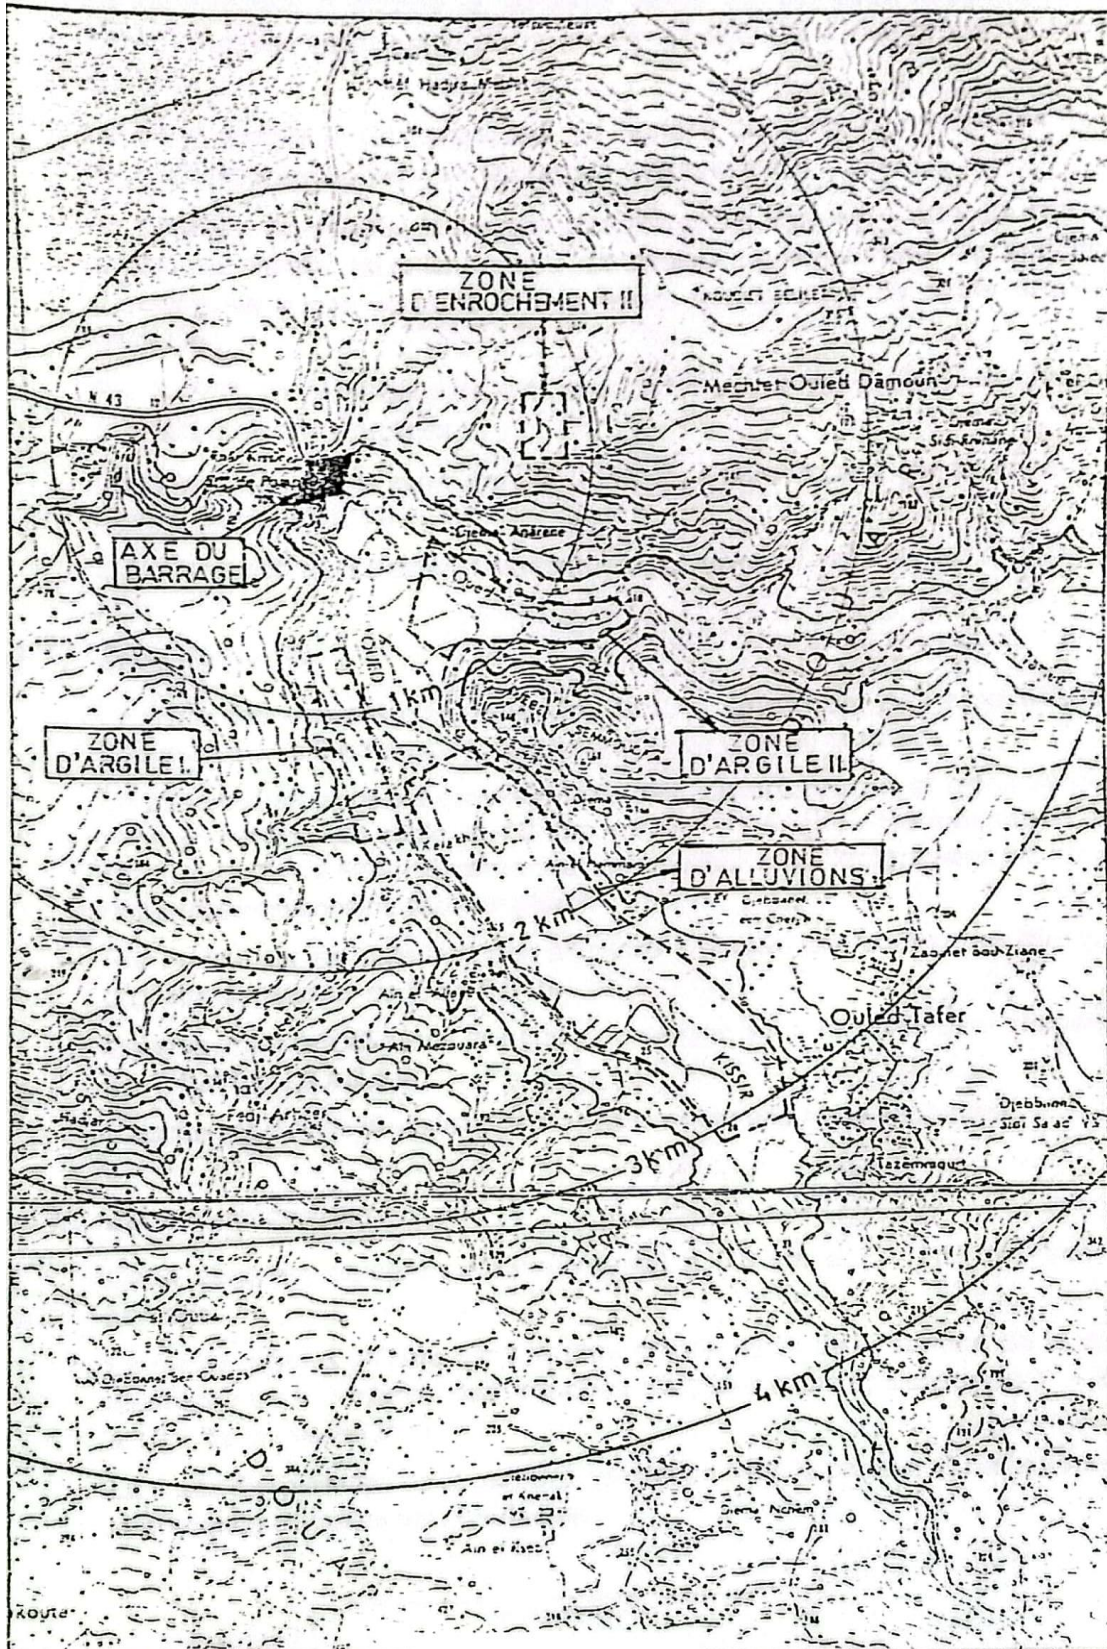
Plan de situation des zones d'emprunt 1/25000 [3].
